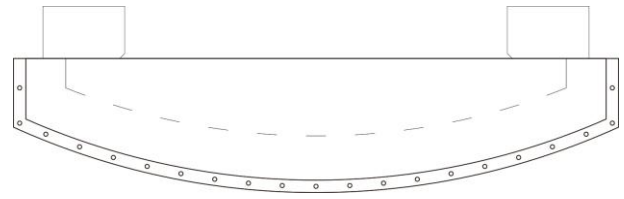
Planta de antepecho de Ventanas, con ubicación de la defensa de hierro forjado.
